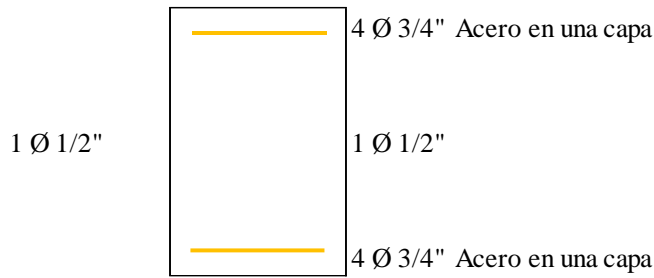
Distribución del Acero longitudinal de VC-102 (40x90) - Sistema estructural tradicional.
